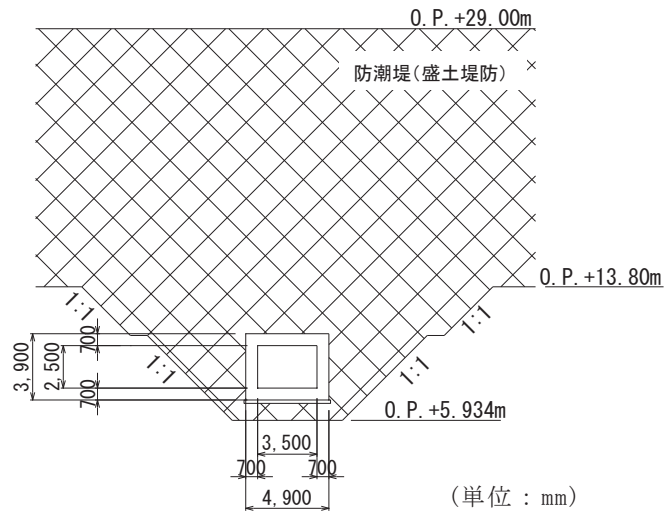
(1) 北側排水路の断面図 (A-A 断面)
